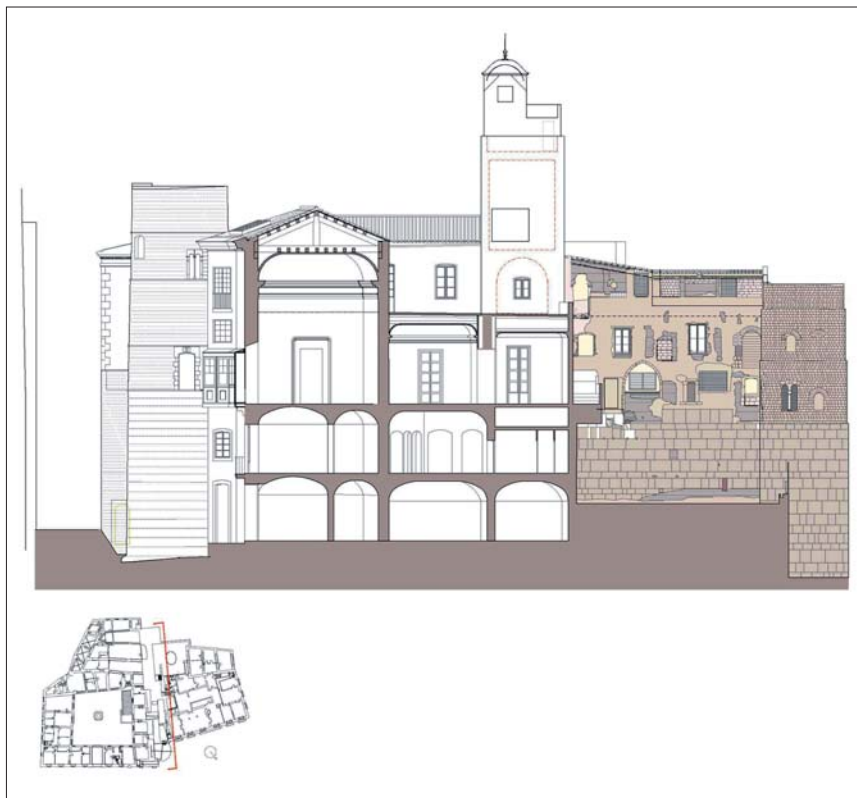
Secció longitudinal del conjunt i alçat actual de la façana exterior de la muralla. Joan Claudi Minguell i Magda Mària.
